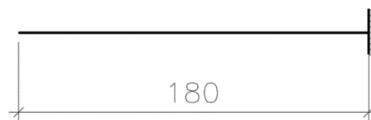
Modelo estrutural adotado para laje do belvedere (fonte: autora)
